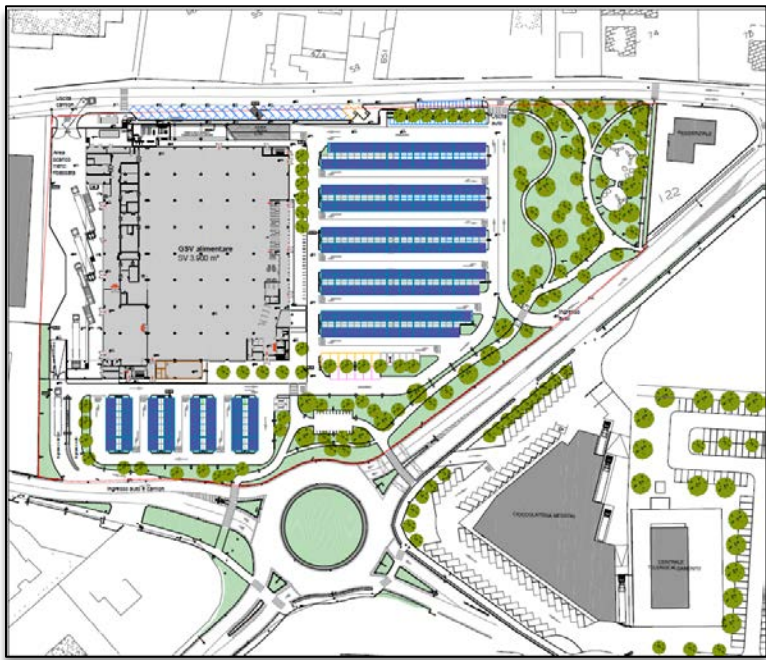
Planimetria generale di inquadramento – soluzione B
